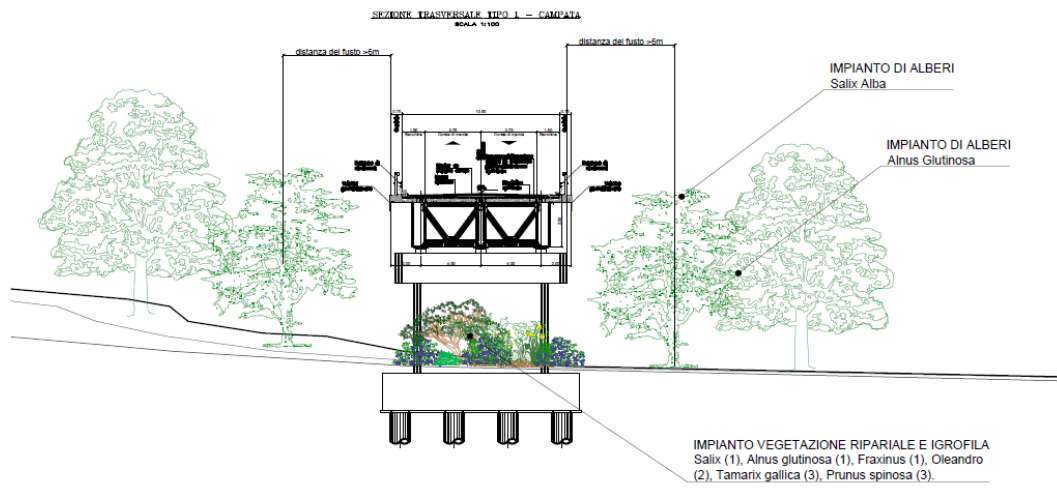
vista del tracciato, viadotto VI04 attraversamento riu Idolo, elementi di mitigazione
